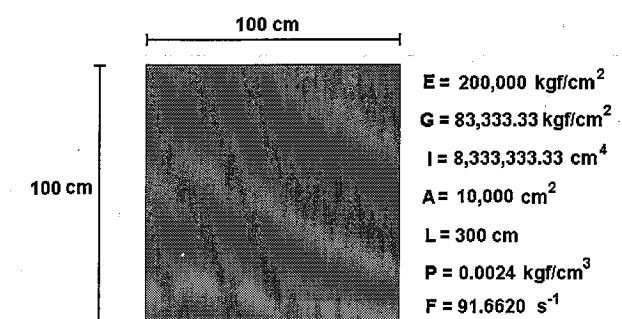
Sección transversal de una viga de concreto cuadrada.
